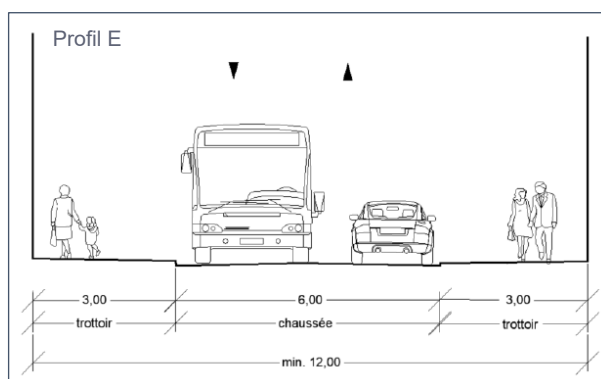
Coupe du scénario 4.E (source : AGORA)
